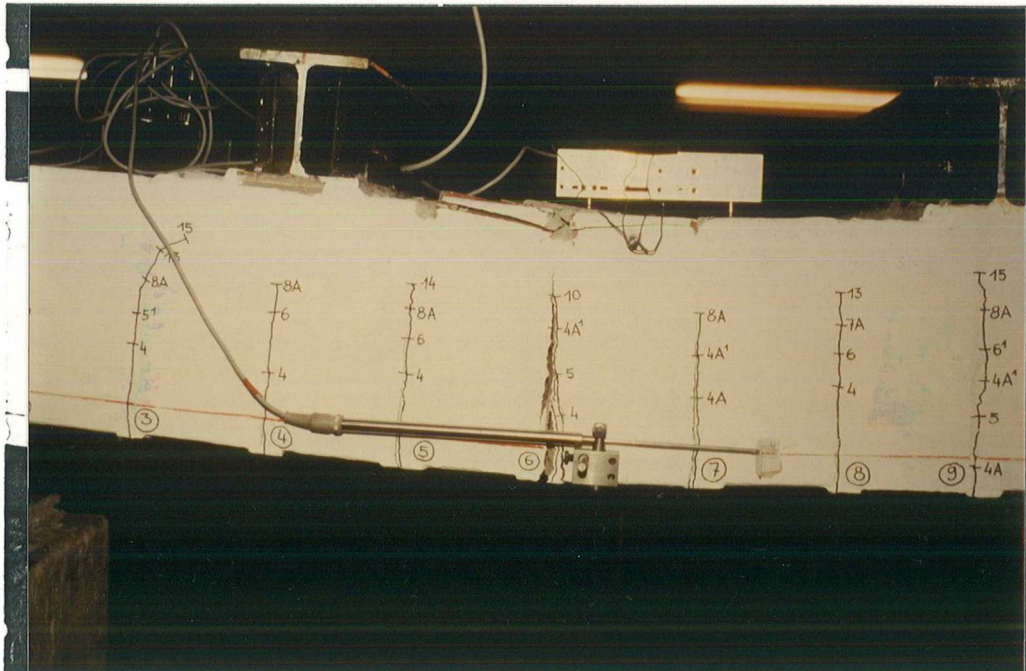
Versuch II/5 nach dem Versagen durch Biegebruch
